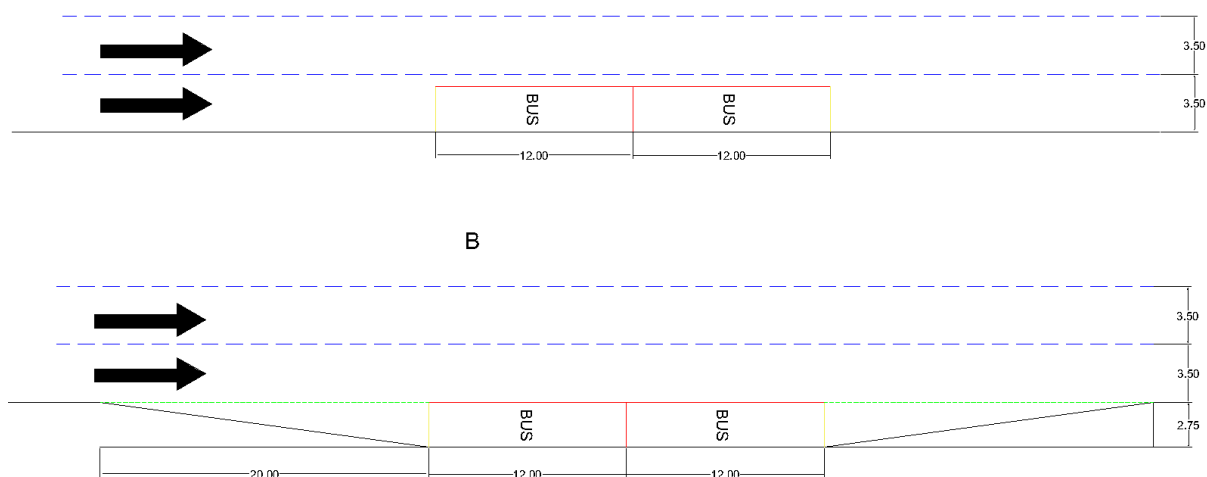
Paraderos en Sitios Múltiples *con propuesta de diseño vista en planta
